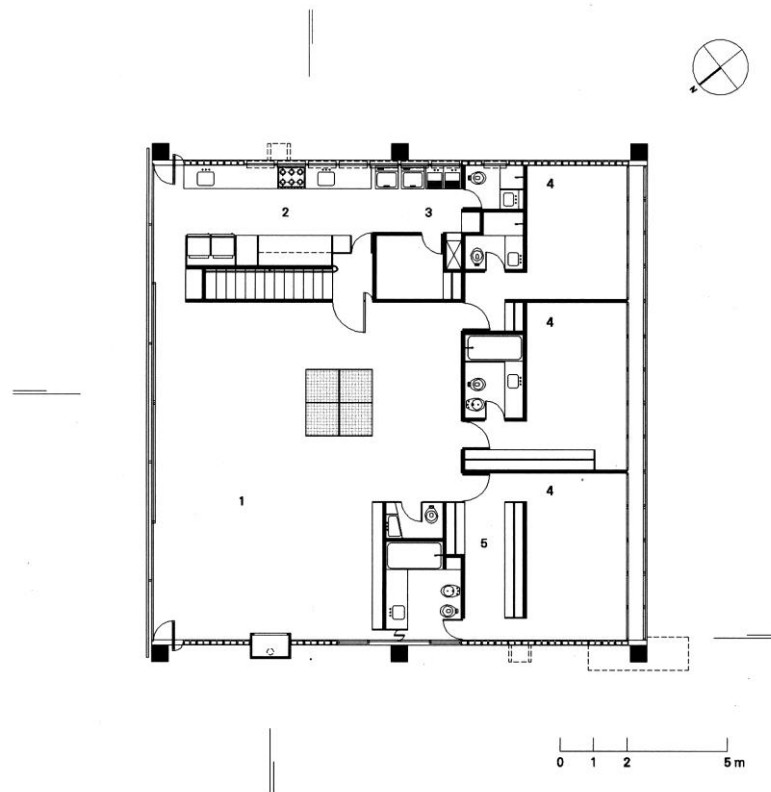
Planta do pavimento superior – Casa Gerassi
